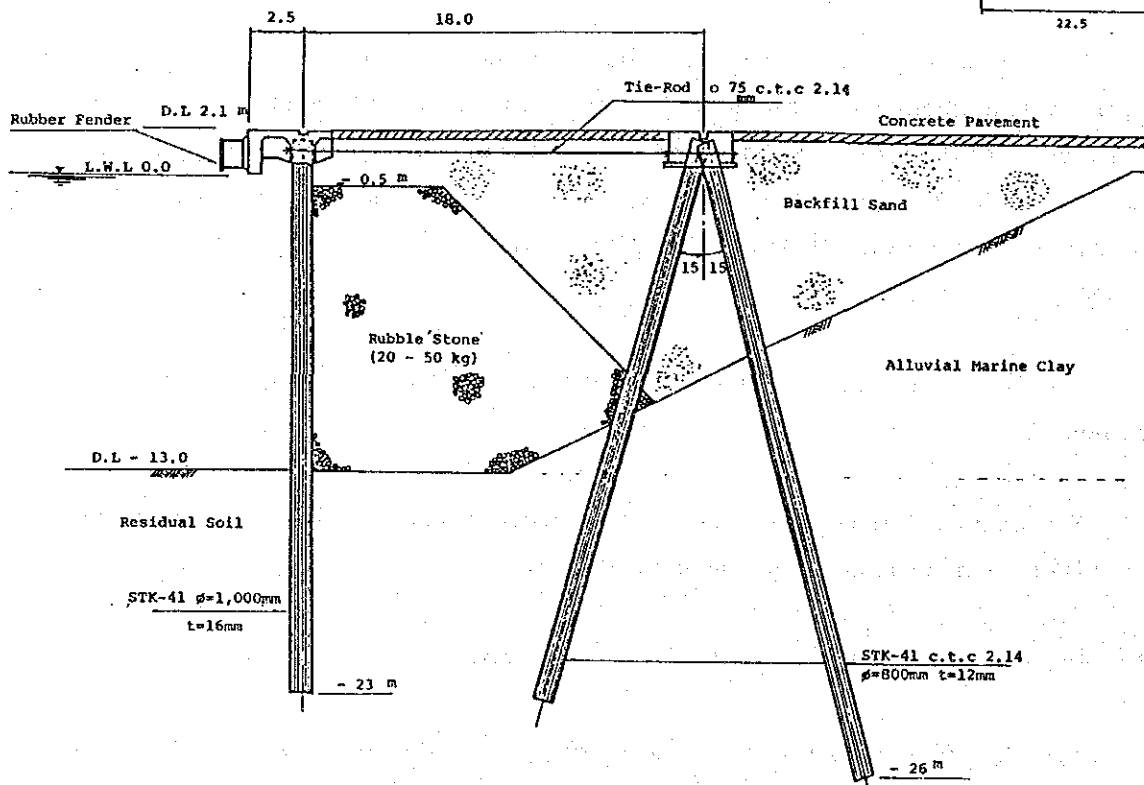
Secciones Transversales Normales del Muelles
